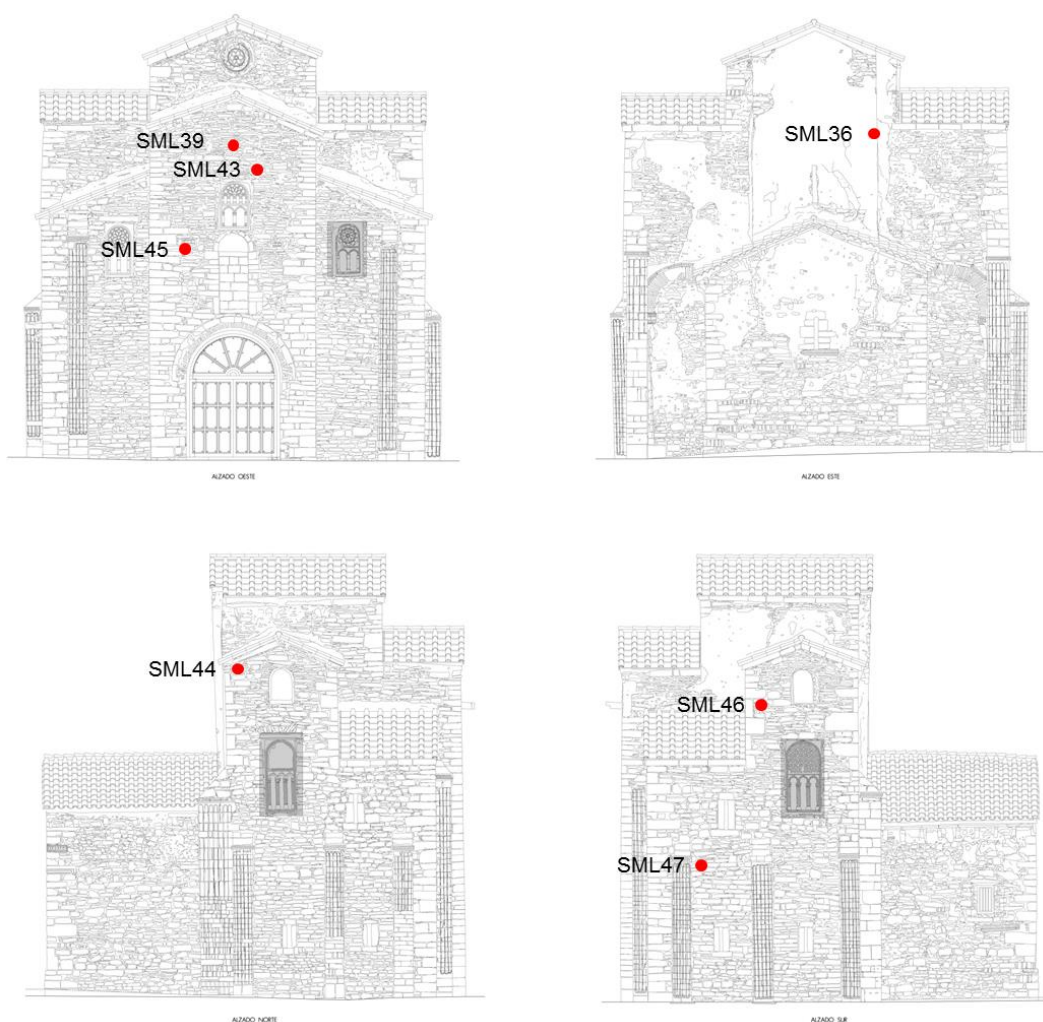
Localización sobre alzados de las muestras de mortero, recogidas en las fachadas.
